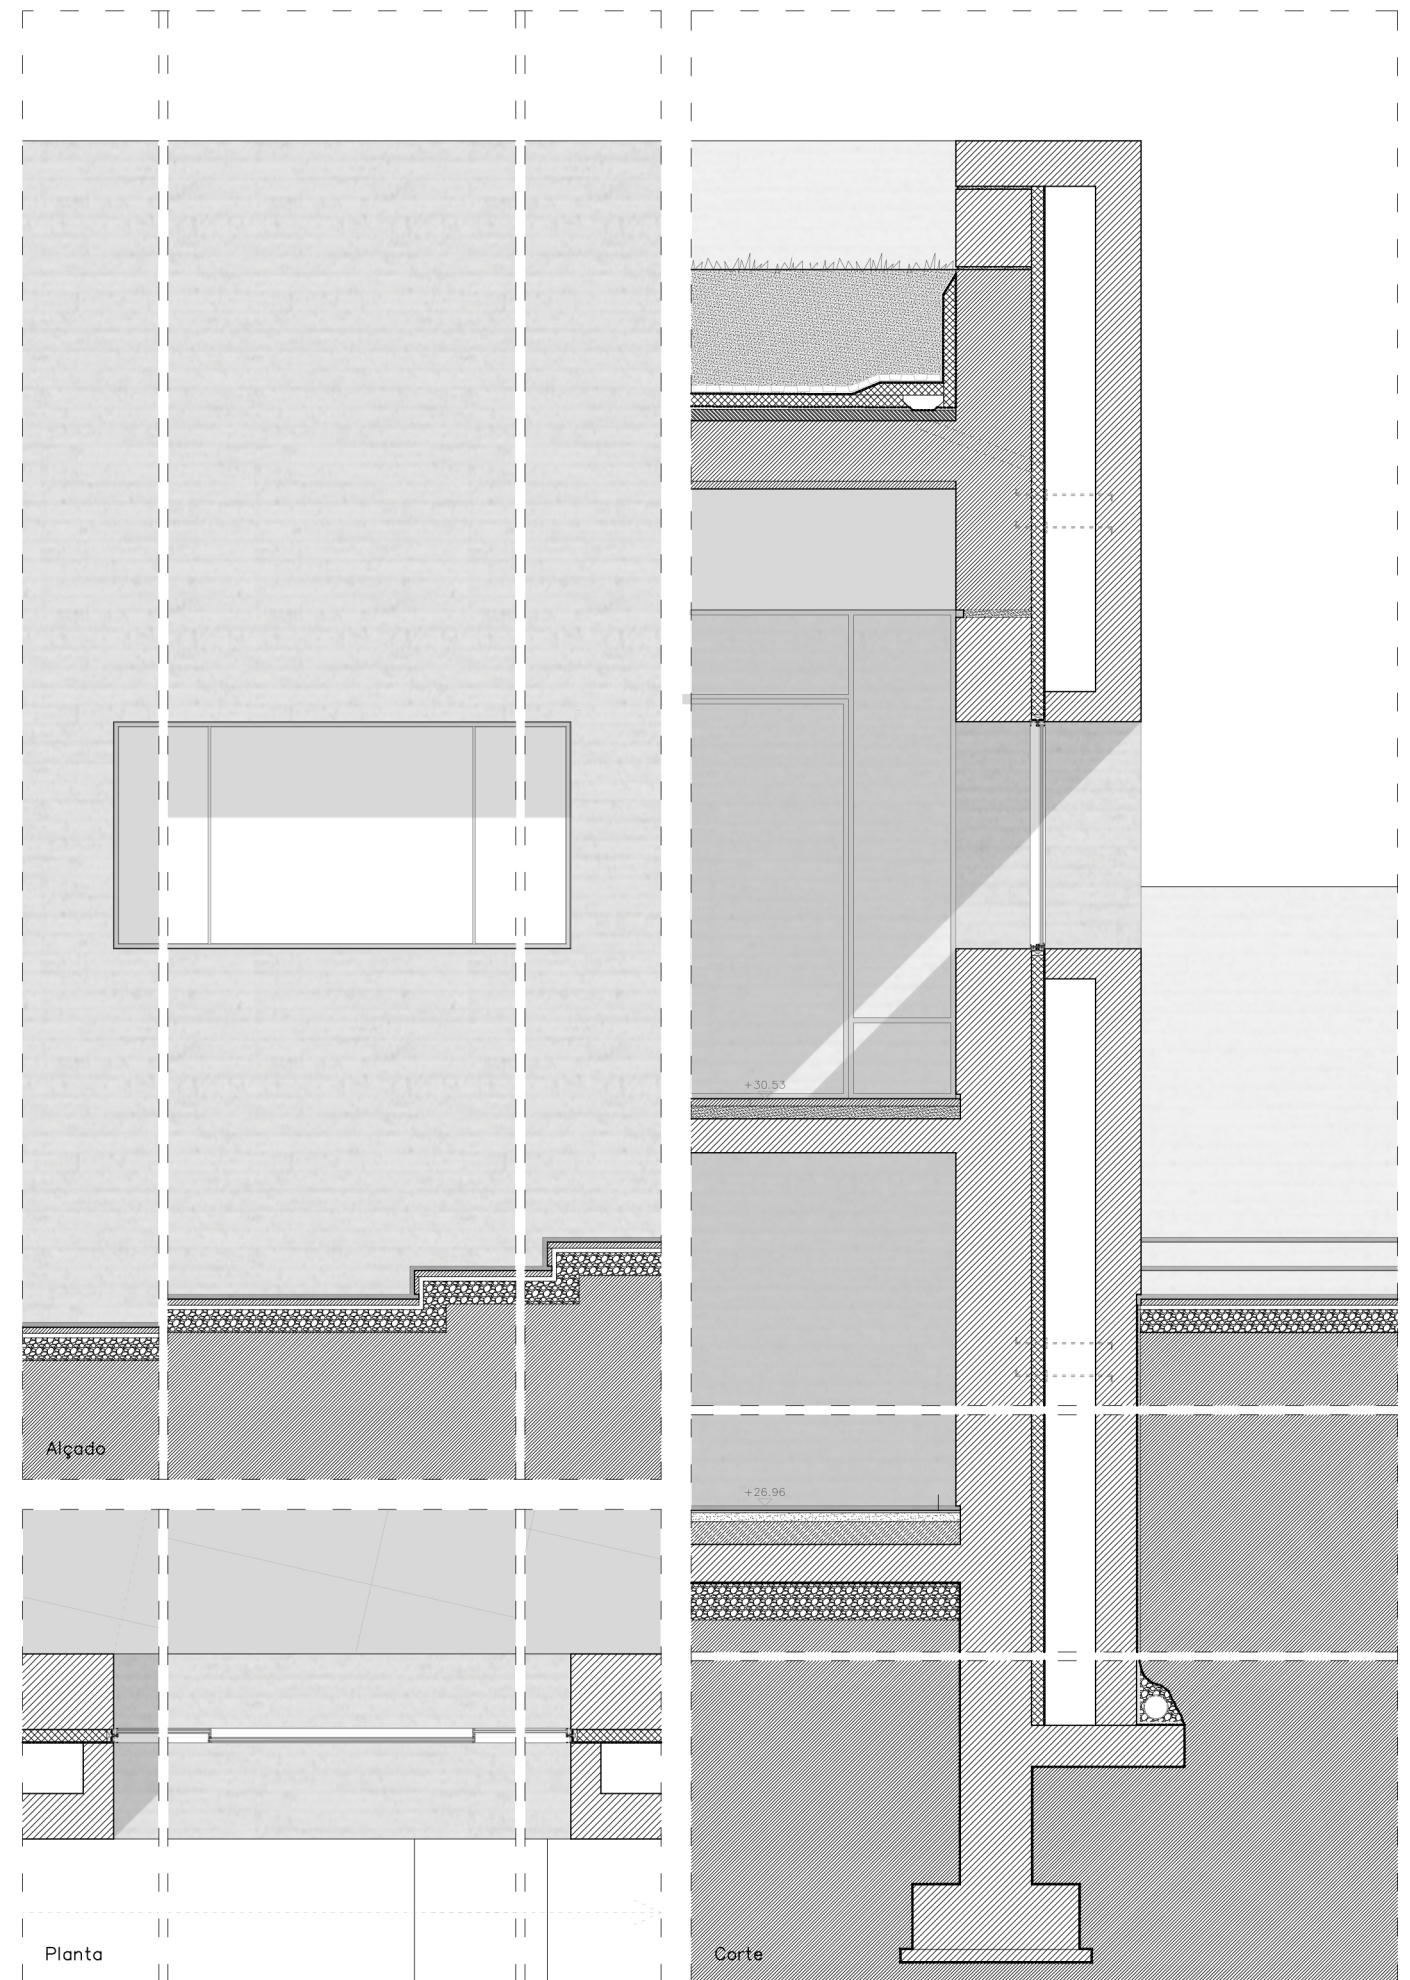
Pormenor construtivo da fachada do novo volume | 1:50
